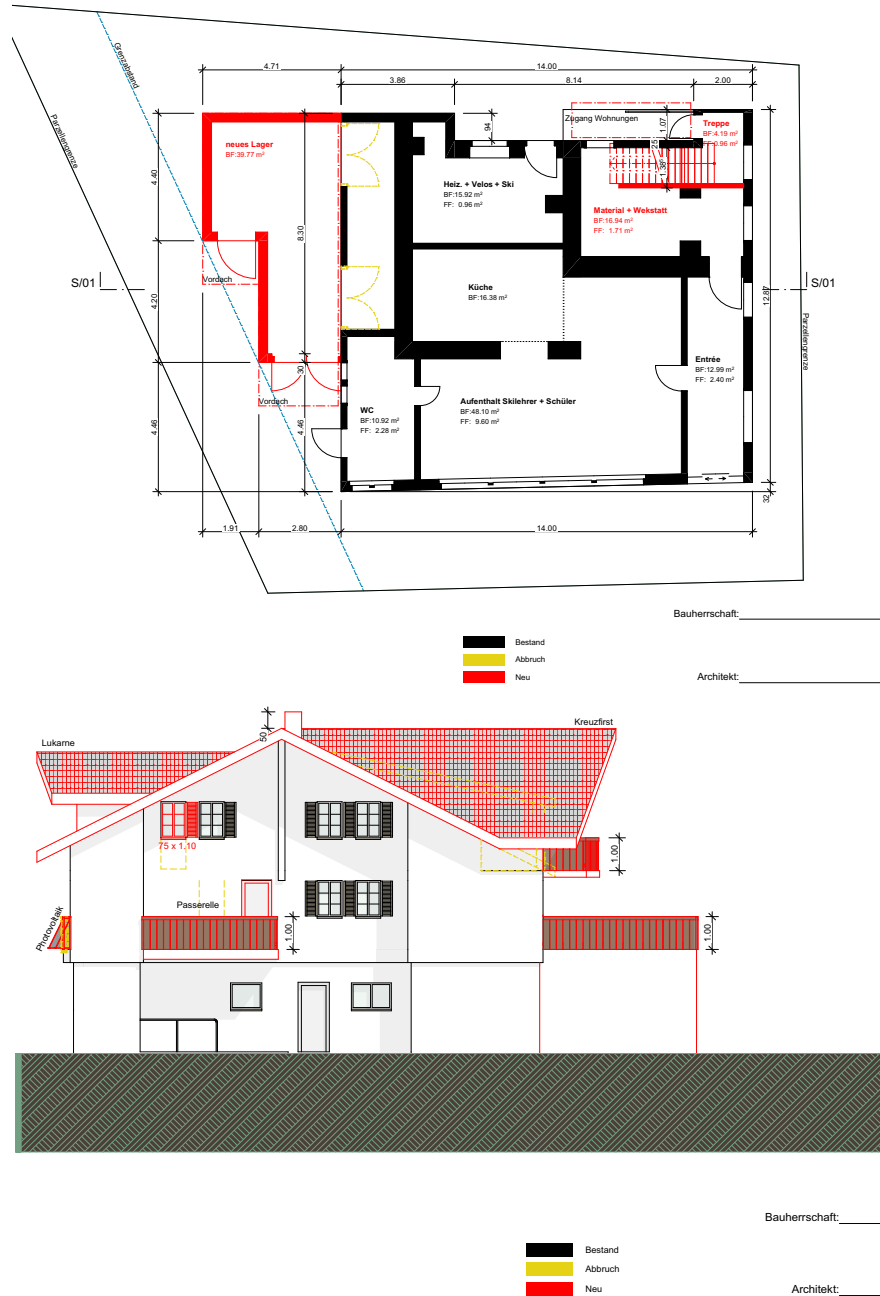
Auszüge aus den Projektplänen; oben Grundriss Erdgeschoss mit Lager-Anbau, unten Fassadenansicht Nordostfassade mit Lager-Anbau, neuen Balkonen und Ausbau Dachgeschoss. Quelle: Nöpflin Bau GmbH, Wengen
